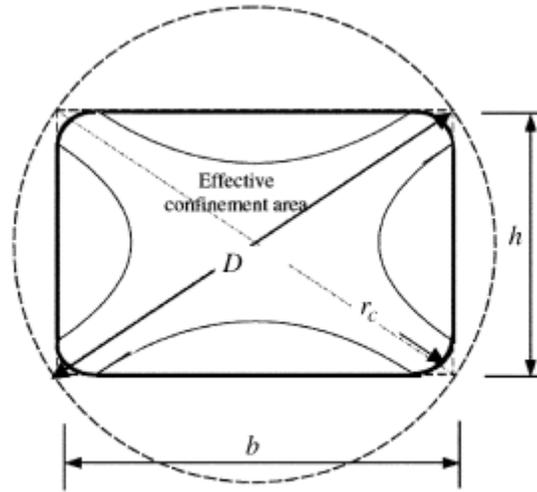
Эквивалентное круглое поперечное сечение.
